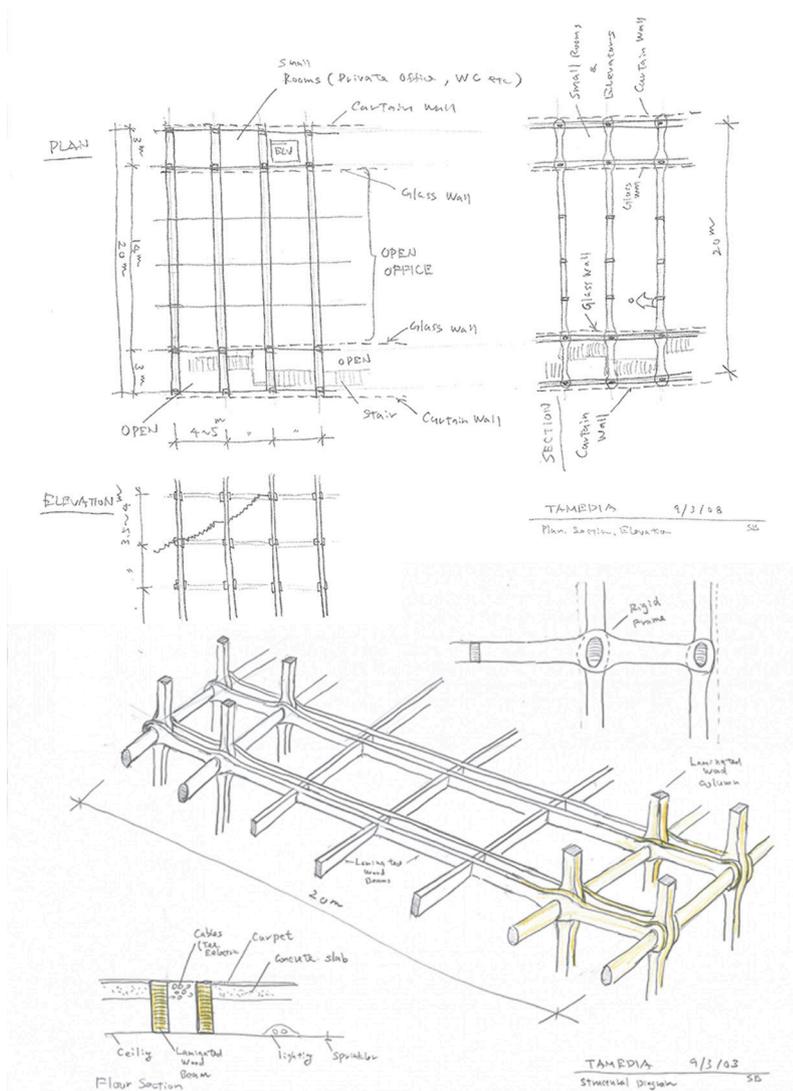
Esquema de estructura con la doble línea de pilares a los extremos y espacio central sin apoyos. Detalle del forjado colocado sobre la estructura.
